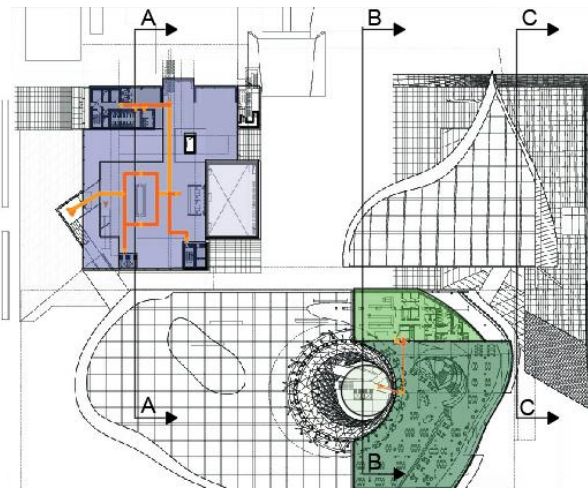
الطابق الأرضي لمركز بوسان السينمائي.
